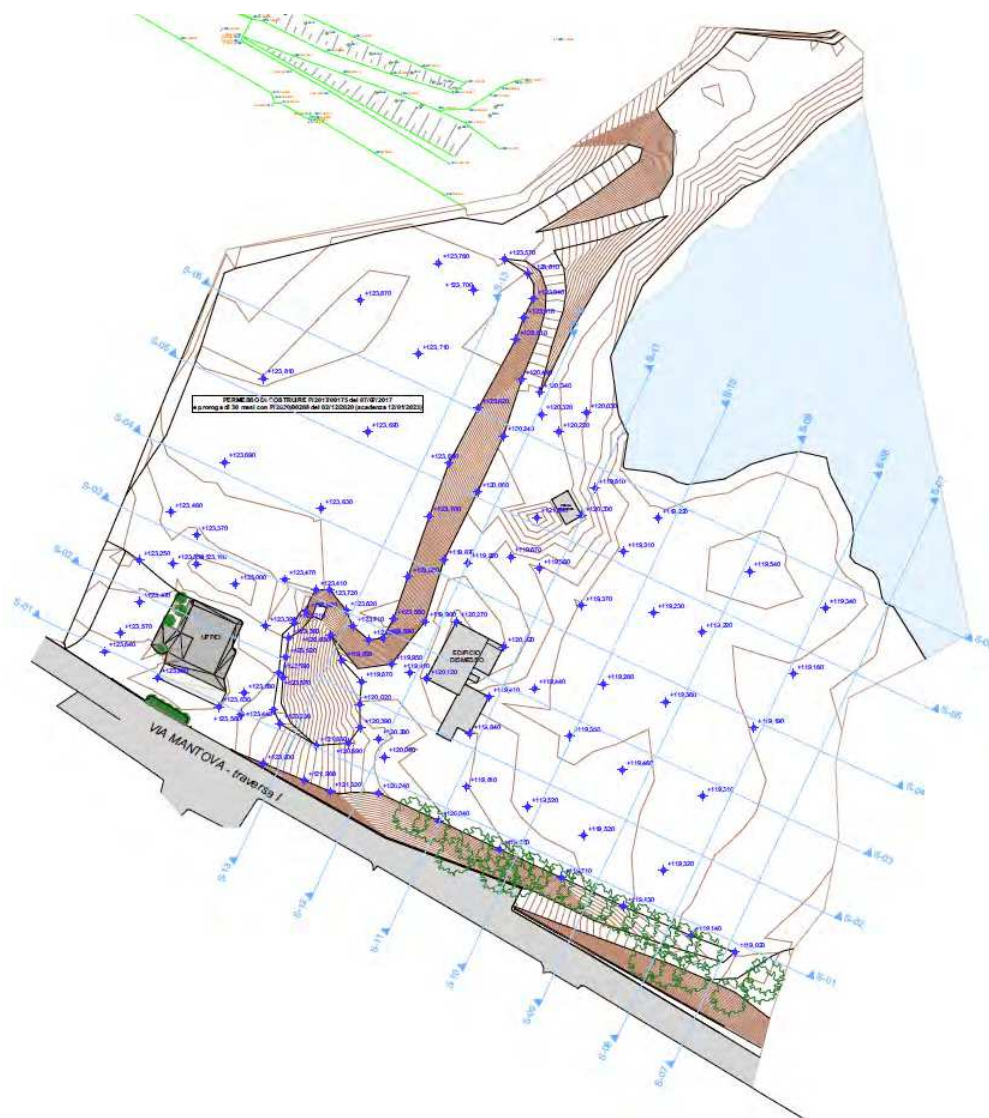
Stato di fatto: planimetria - estratto della Tav. A03 di rilievo
